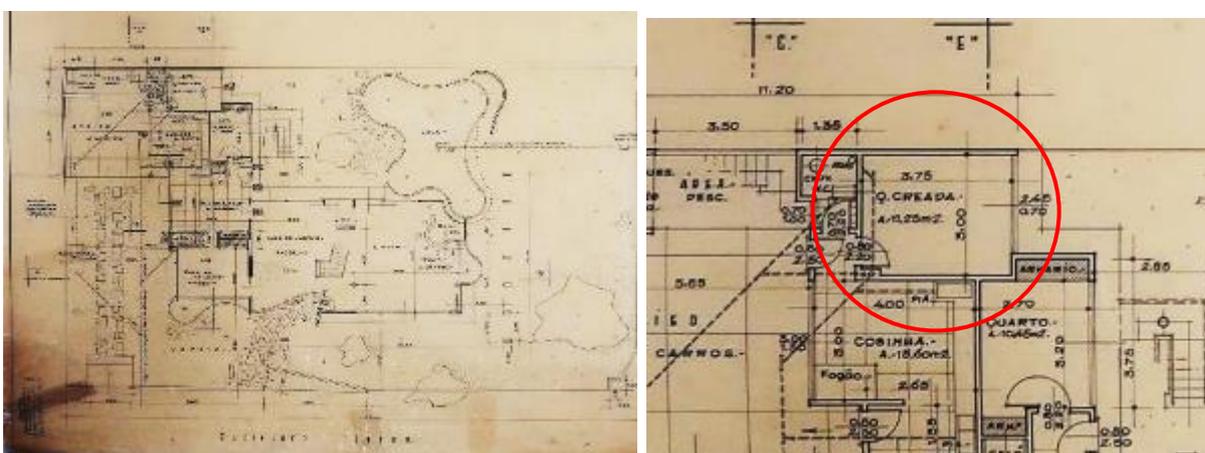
Casa Belisário Dias – Planta Baixa Pav. Térreo e detalhe “Q. Creada” (1954) – pranchas originais digitalizadas. Fonte: Acervo LAHCA.
